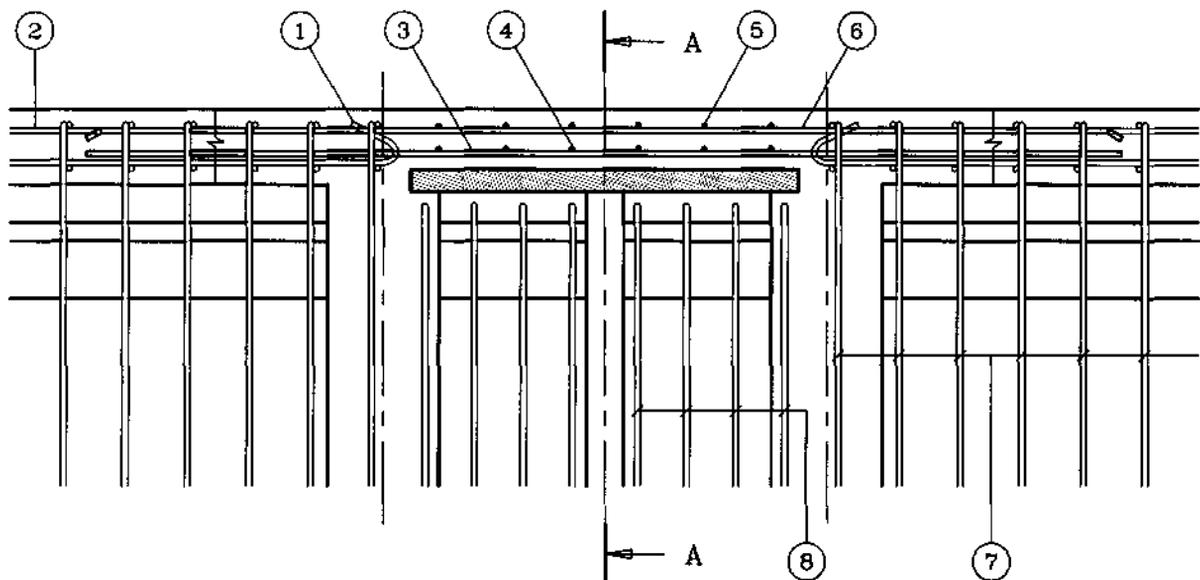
Ferrailage des dalles : Coupe longitudinale à mi-distance des poutres
